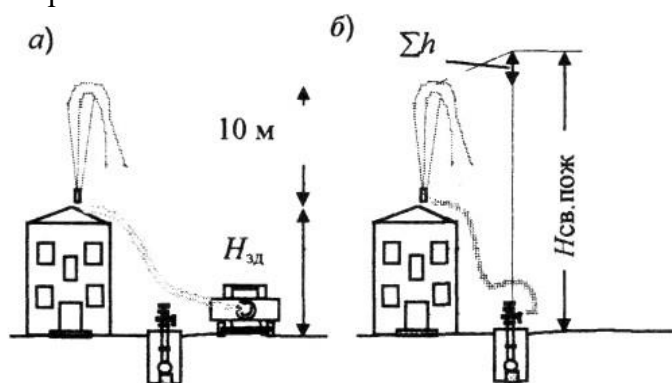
Схемы тушения пожара из водопровода: а - низкого давления; б - высокого давления
